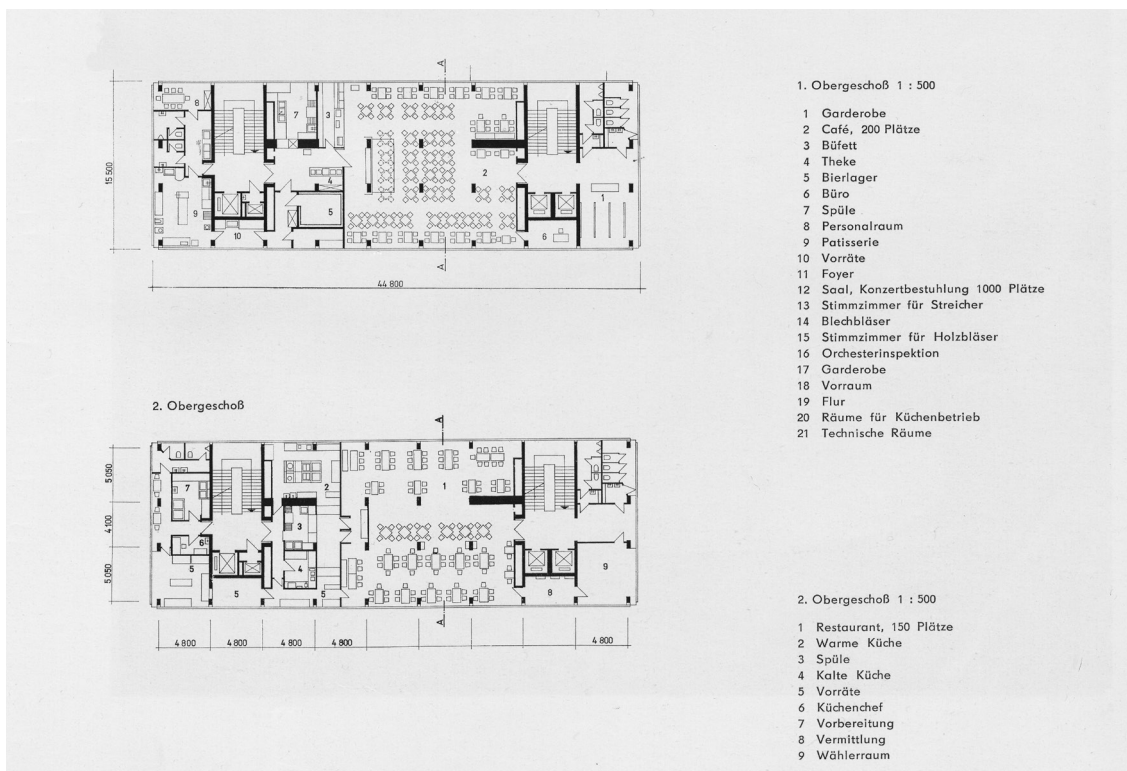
Haus des Lehrers, Grundrisse des ersten und zweiten Obergeschosses mit dem Café und dem Restaurant Forum, 1964
